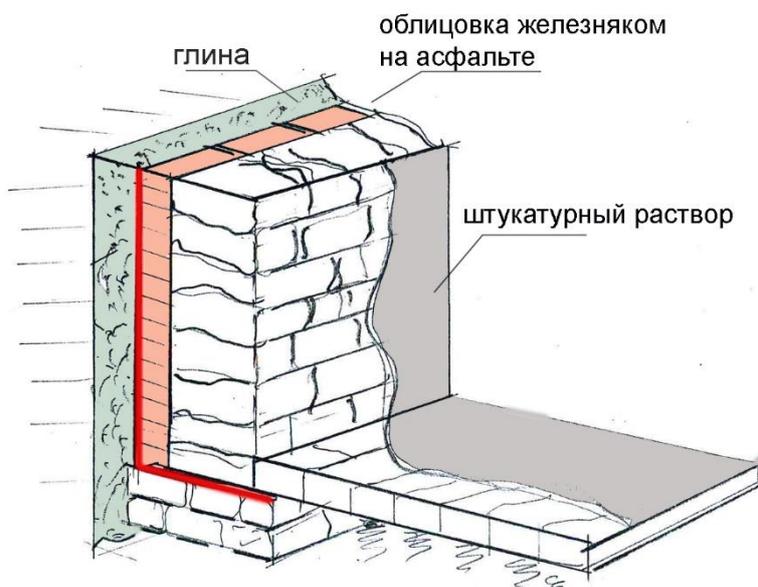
Вариант гидрозащиты стен и подвальных помещений от грунтовой влаги с использованием глиняного замка
